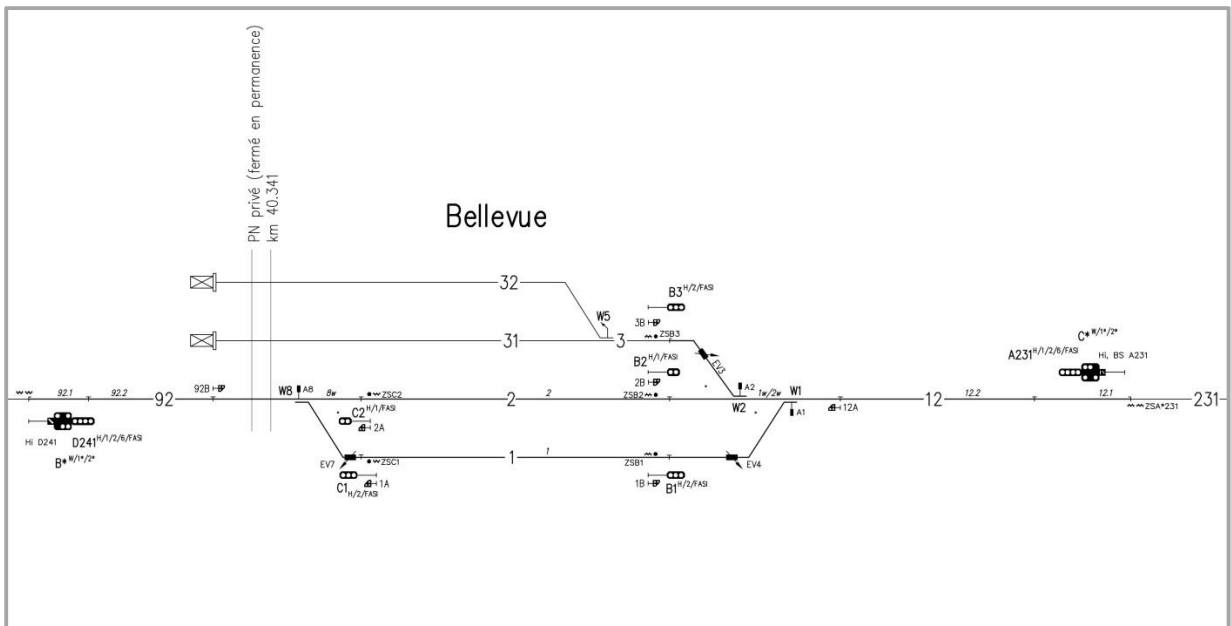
Extrait d'un plan d'ensemble (exemple : CJ, Bellevue)
